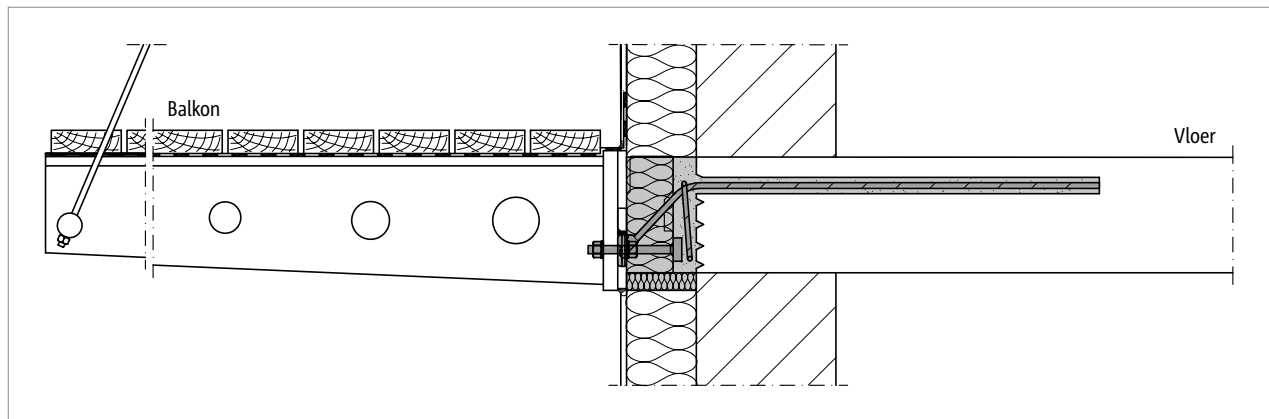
Schöck Isokorb® RT type SQ: Vernieuwing van een bestaand balkon, ondersteunde constructie
